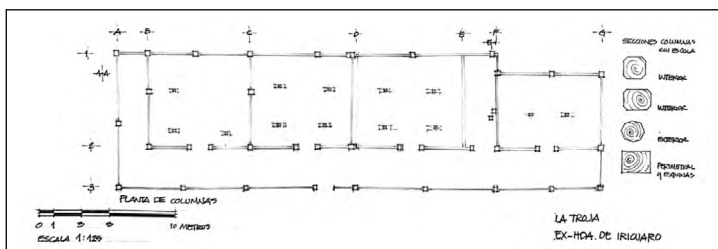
Planta arquitectónica con columnas y habitaciones.
